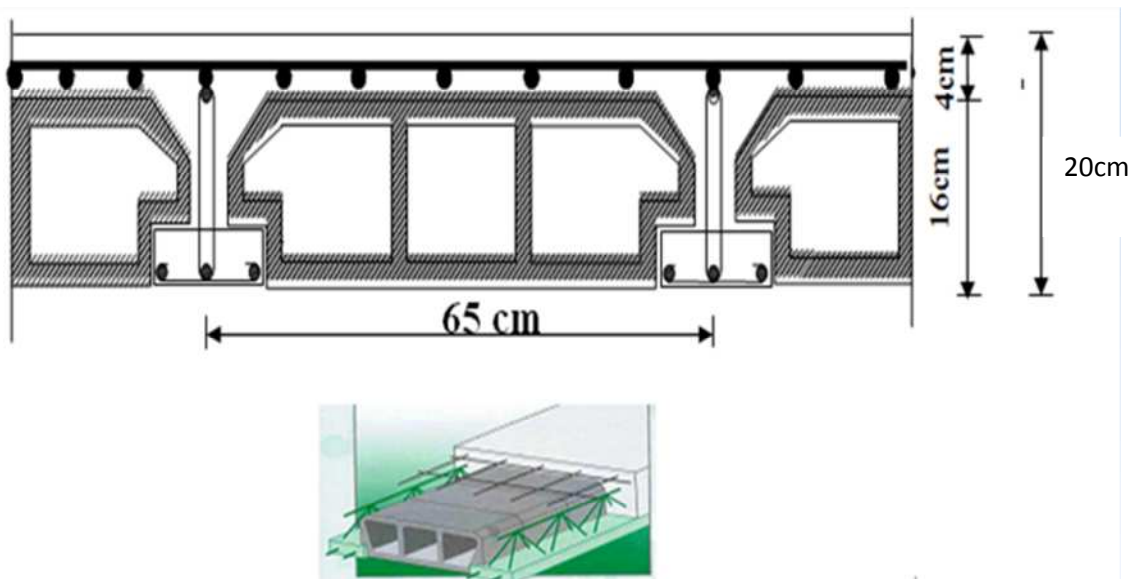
Eléments constitutif d'un plancher a corps creux
